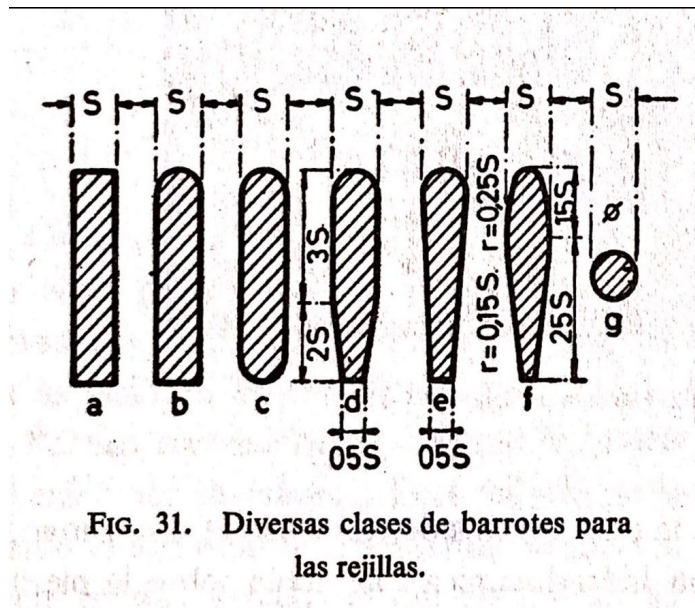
Secciones de rejillas posibles, según Zoppetti
